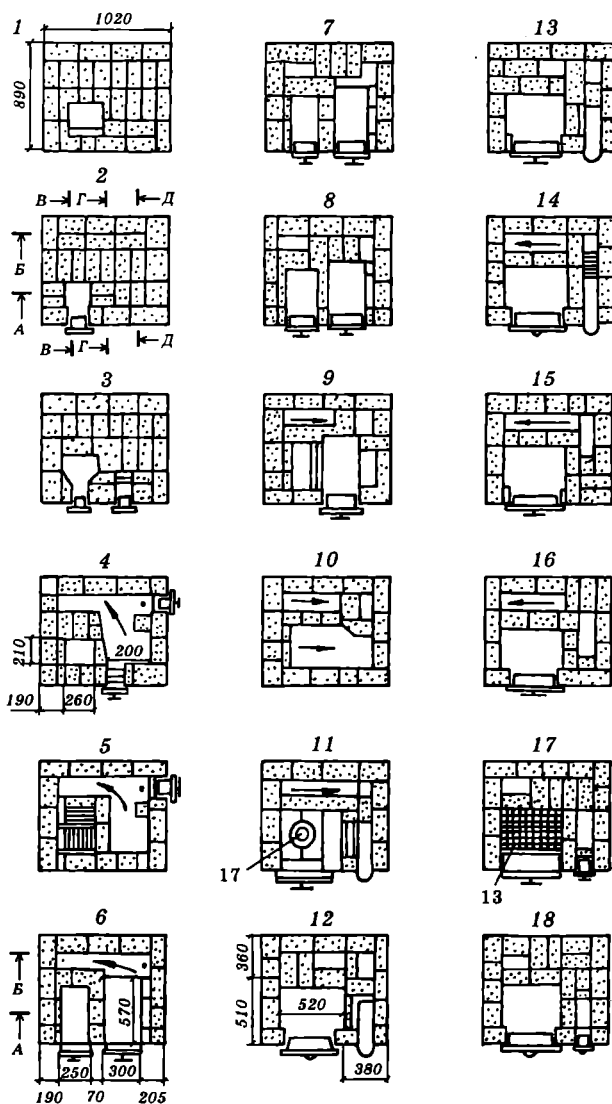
Порядовка кладки отопительно-варочной печи конструкции И.Ф. Волкова
